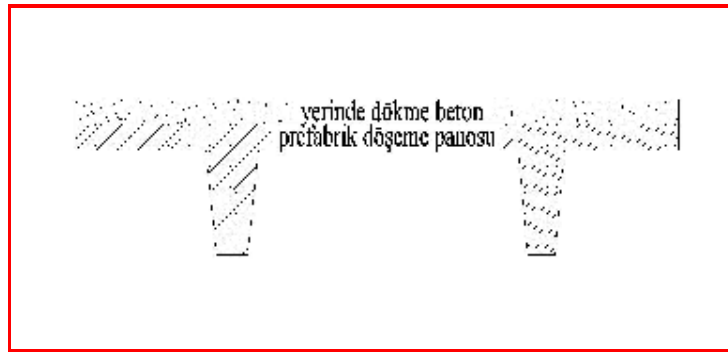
'de en kesiti gösterilmiş veya benzer biçimde olan betonarme öngerilmeli beton veya betonarme panolarla oluşturulurlar. Boşluklu olarak oluşturulan döşeme sistemlerinde kullanım durumundayken aşırı yüklerden dolayı kesme kuvvetlerinin artması durumunda boşluklar üzerindeki beton parçası kırılarak boşluklar betonla doldurulabilir.
